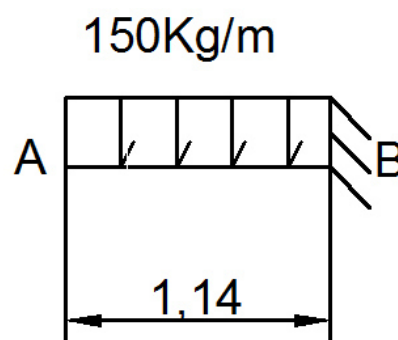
Calculo estructura. Primer TRAMO AB.
